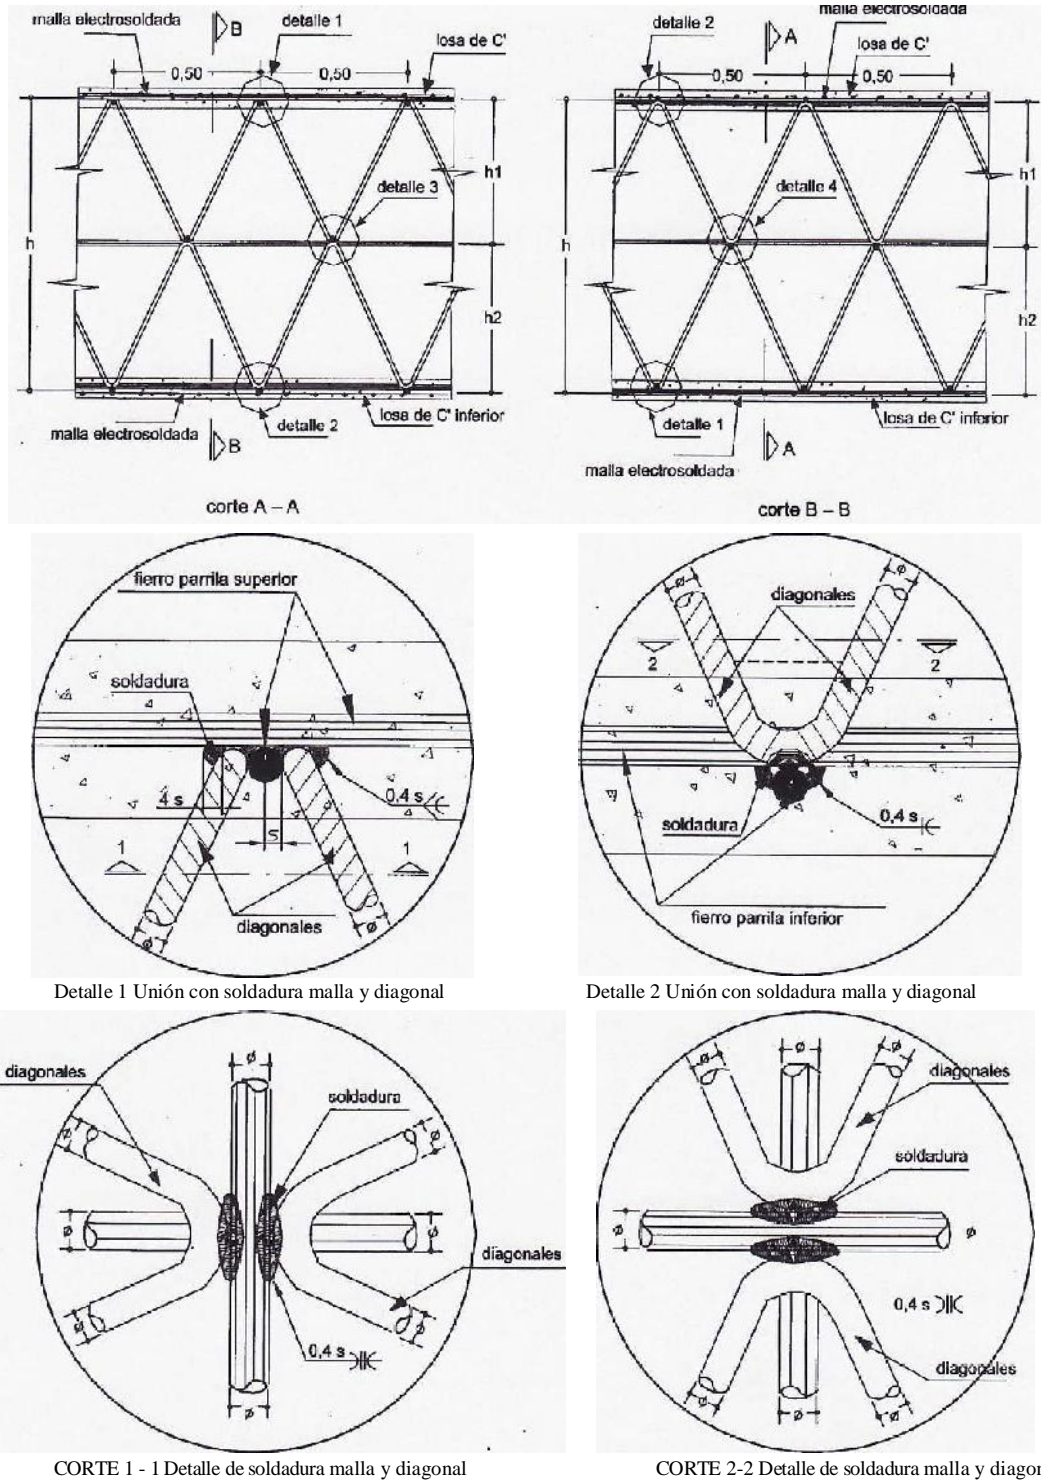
Detalles de unión soldada entre mallas y diagonales
